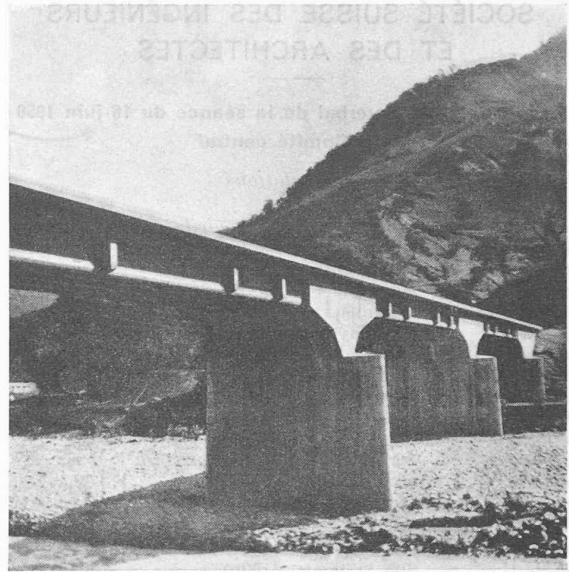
Pont de Darguinah en voie d'achèvement.
